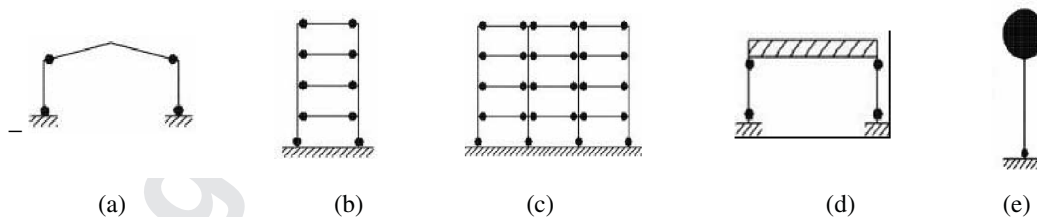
Configurazioni dissipative di strutture intelaiate: disposizione delle cerniere plastiche, secondo le tipologie esposte nella tabella 7.5.II del § 7.5.2.2 delle NTC.
